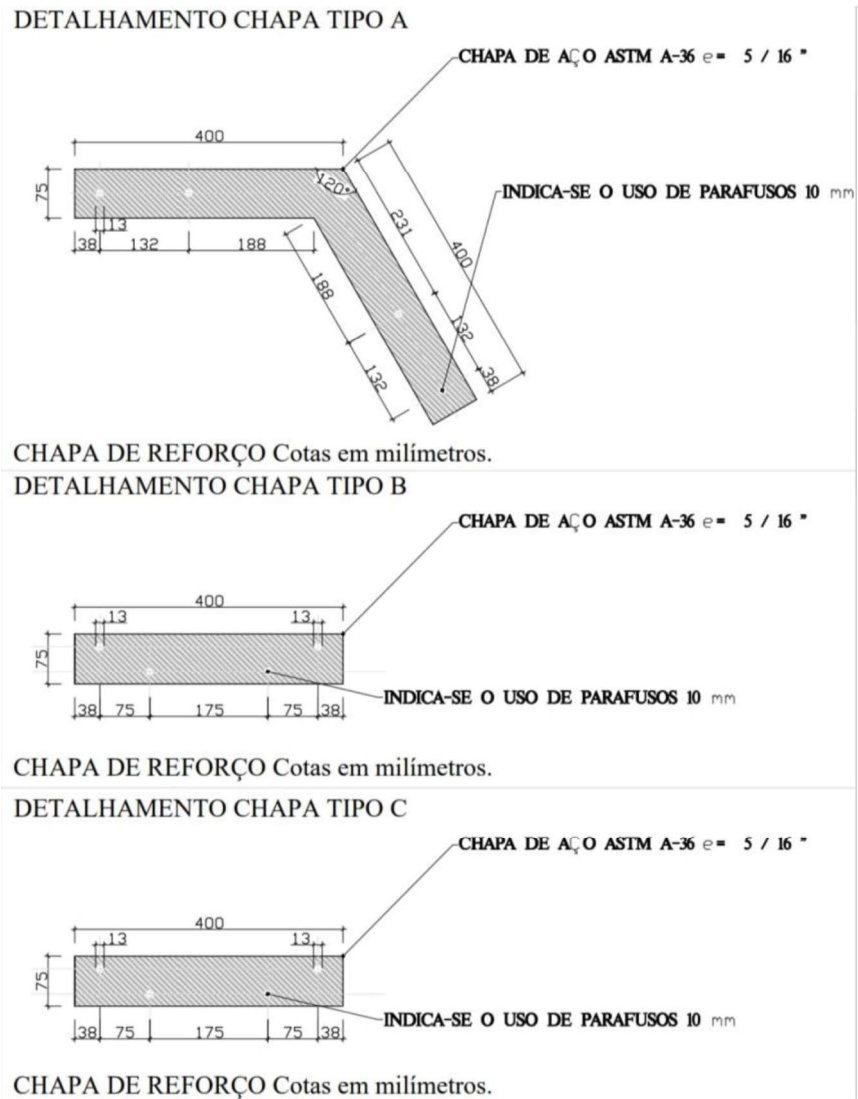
Detalhamento dos componentes metálicos utilizados como reforço estrutural no telhado.
